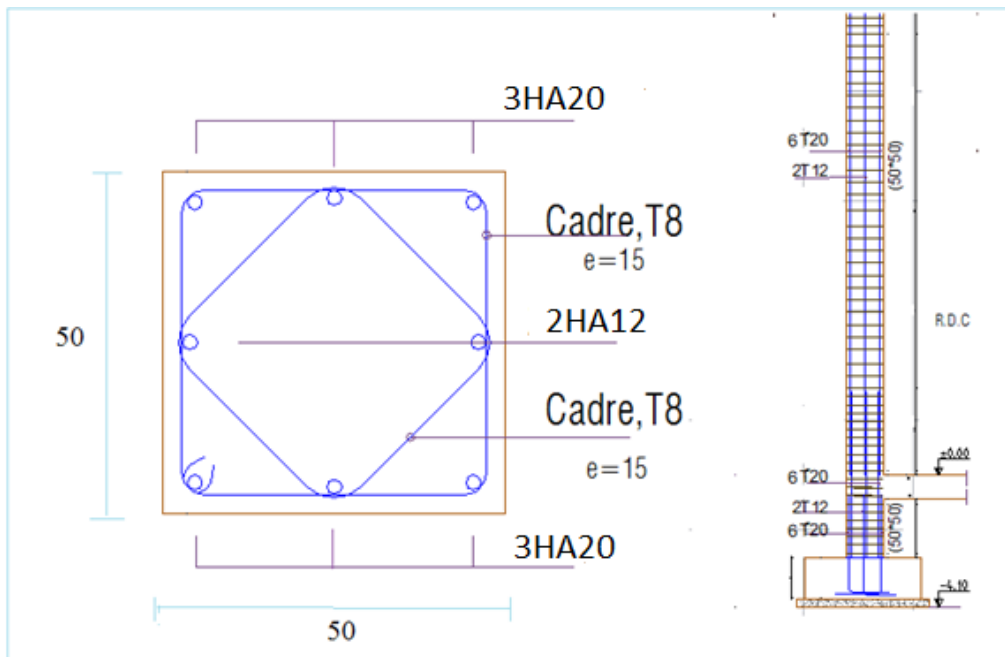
schéma de ferrailage du poteau par Autocad2012.
